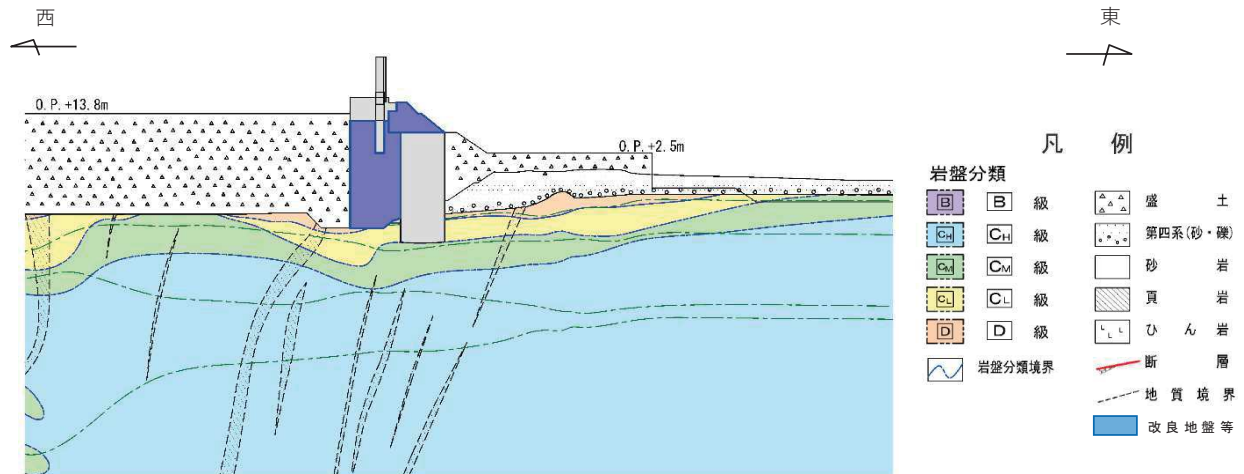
鋼管式鉛直壁（一般部）I-①断面（断面①）
